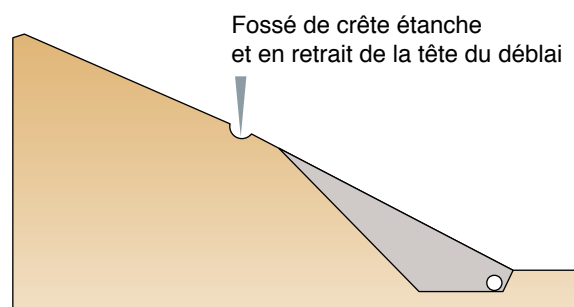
Disposition d'un masque drainant en pied de versant instable.
